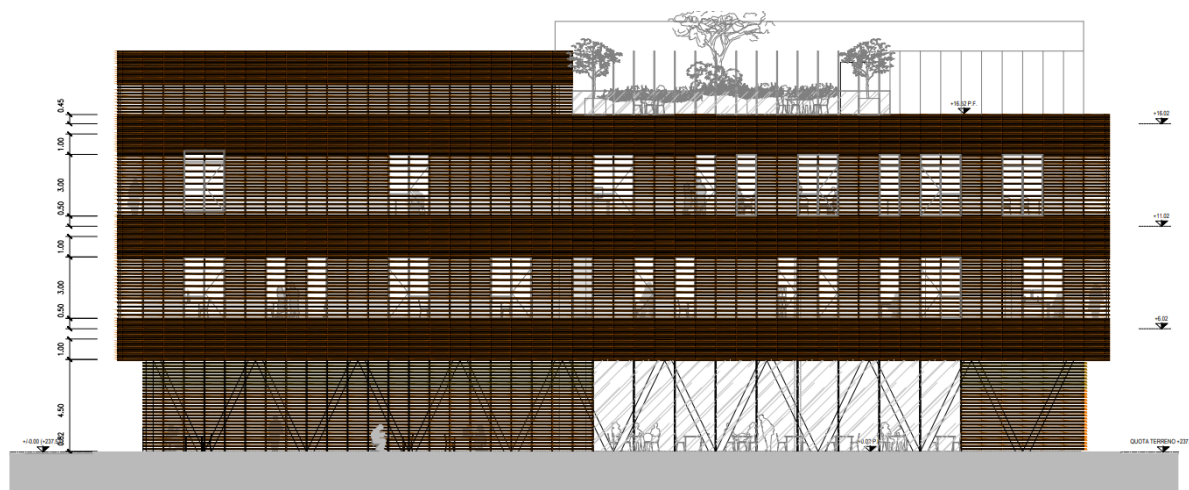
Prospetto deposito Rebaudengo- facciata Est
